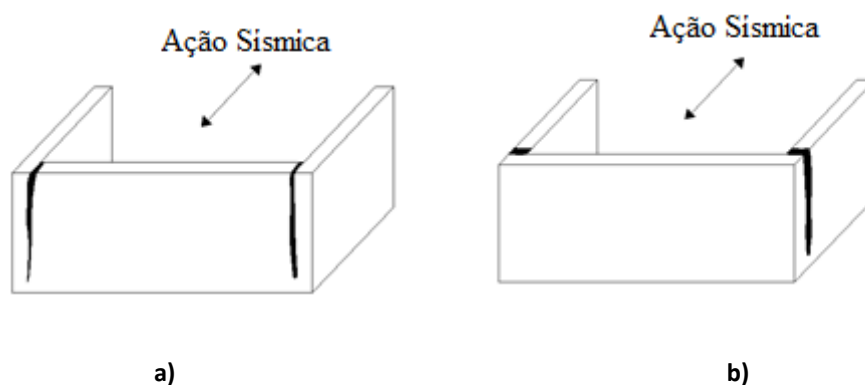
Fissuração nos cunhais: a) Forças de corte b) Forças fora do plano (Costa – 2013)
